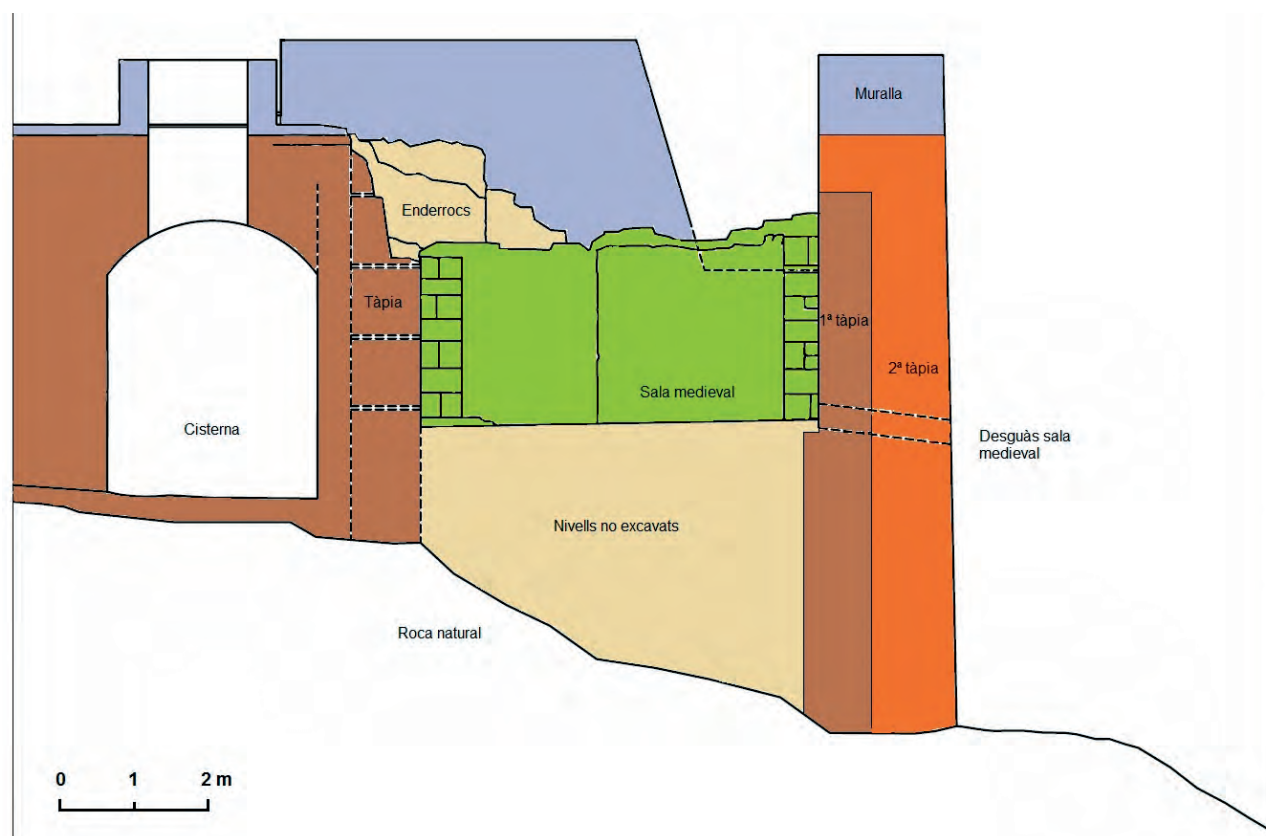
Secció de l'excavació entre els aljubs, la sala gòtica i les muralles de la cara nord del castell.
